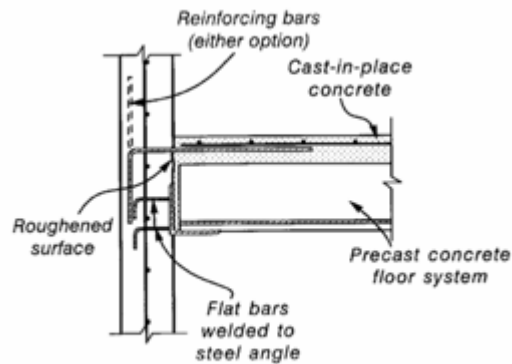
Muro continuo con repisa de acero (fib, 2003).
